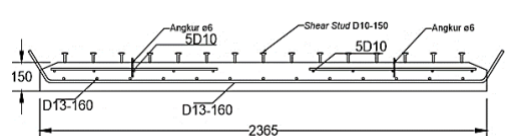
Potongan memanjang detail penulangan balok pracetak
